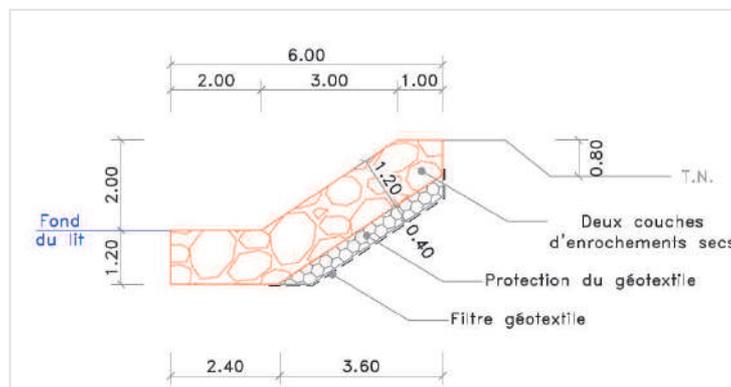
coupe-type de l'ouvrage à mettre en place sur le tronçon 1 et la partie aval du tronçon 2
